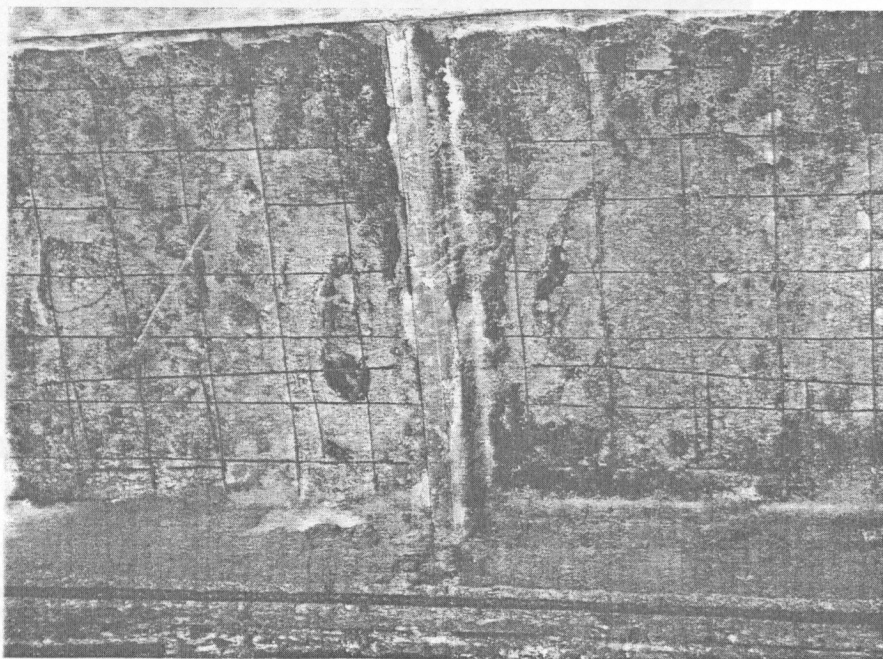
Руйнування захисного шару в плитах перекриття:
